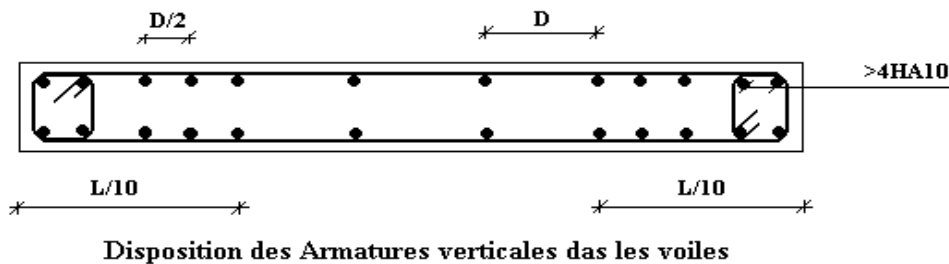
Disposition des Armatures verticales dans les voiles.
